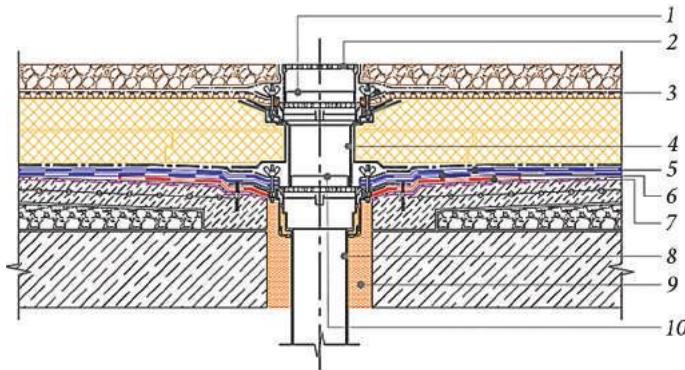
Двухуровневая воронка внутреннего водостока: 1 — дренажное кольцо D1; 2 — водосливный трап; 3 — прижимной фланец; 4 — надставной элемент; 5 — верхний слой кровельного покрытия; 6 — нижний слой кровельного покрытия; 7 — слой усиления из кровельного материала; 8 — водоприемная воронка; 9 — монтажная пена; 10 — дренажное кольцо D2
